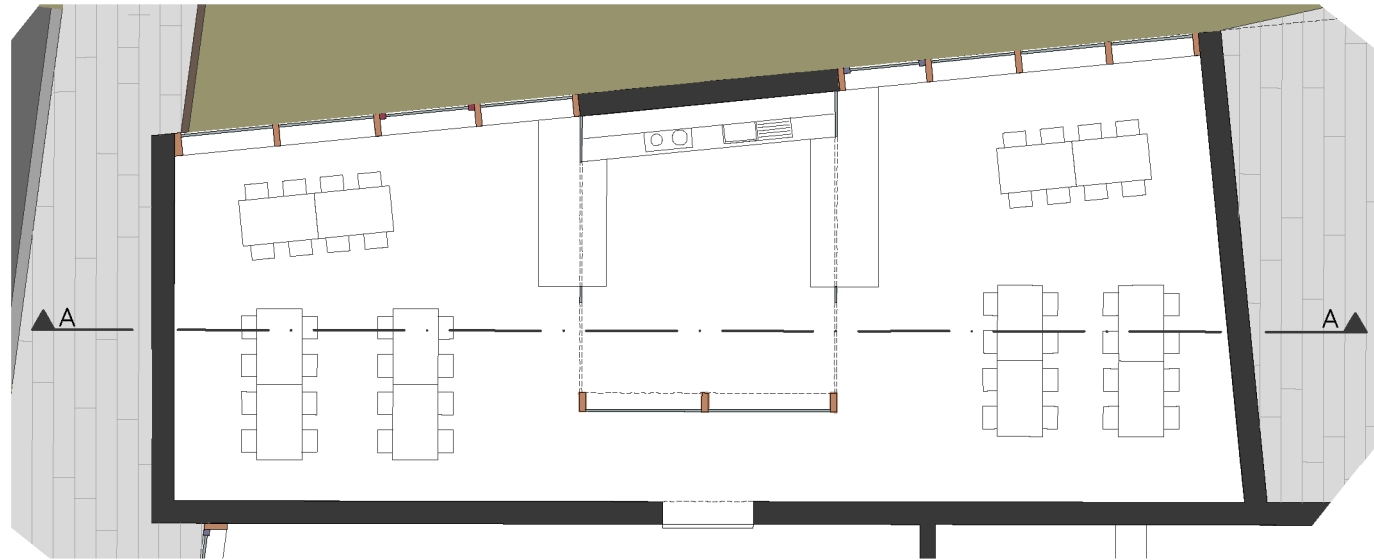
Grundriss Speiseraum und Küche 1:100
